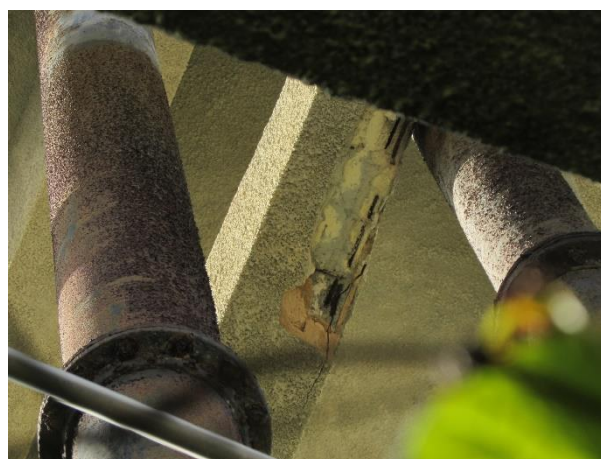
Deslocamento do concreto com corrosão da armadura na viga interna de travamento.
